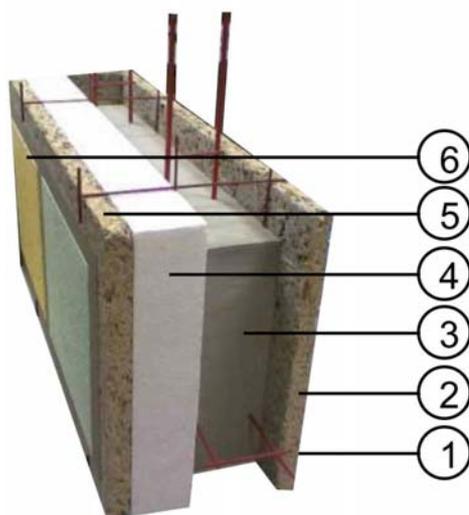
Фрагмент наружного ограждения с применением несъемной опалубки из щепоцементных плит: 1 - внутренний слой отделки (цементно-песчаная штукатурка); 2 - щепоцементная плита; 3 – железобетон; 4 - утеплитель пенополистирол (наружная сторона); 5 - щепоцементная плита; 6 - наружная отделка.
